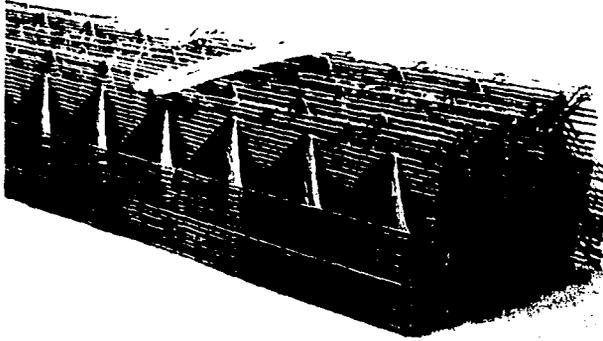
Armadura para viga. (Fotografías Cortesía DEACERO) Figura. III.12 Viga con patin de concreto.
